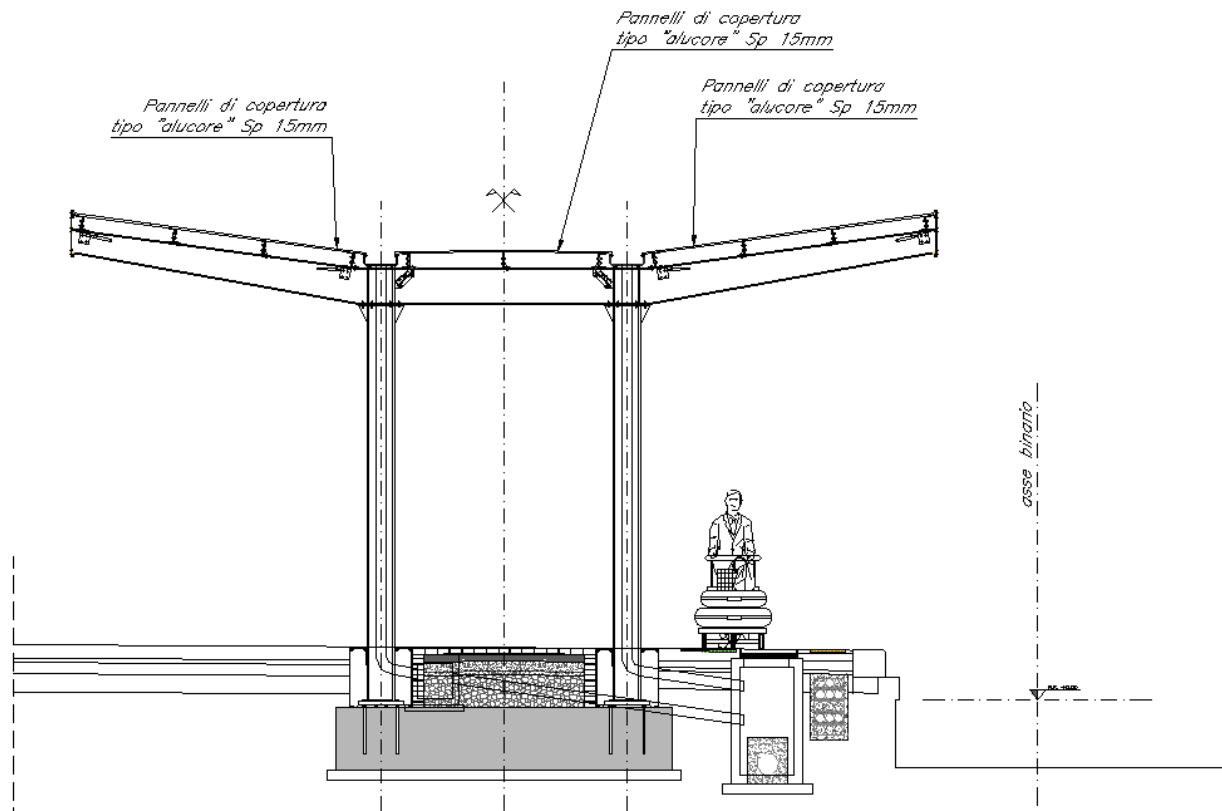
Sezione pensilina ferroviaria 3° marciapiede
